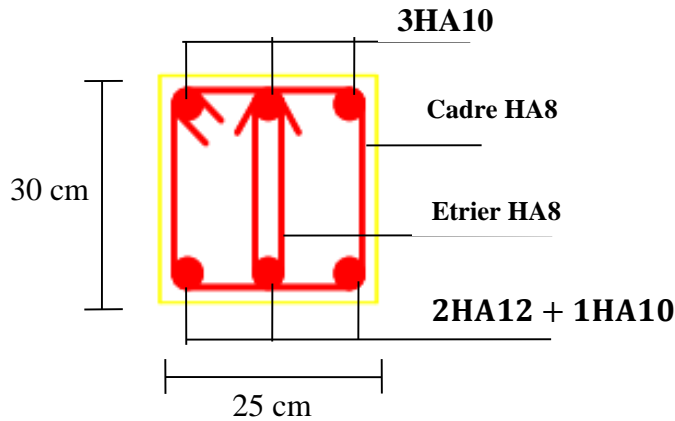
Schéma de ferrailage de la poutre de chaînage
